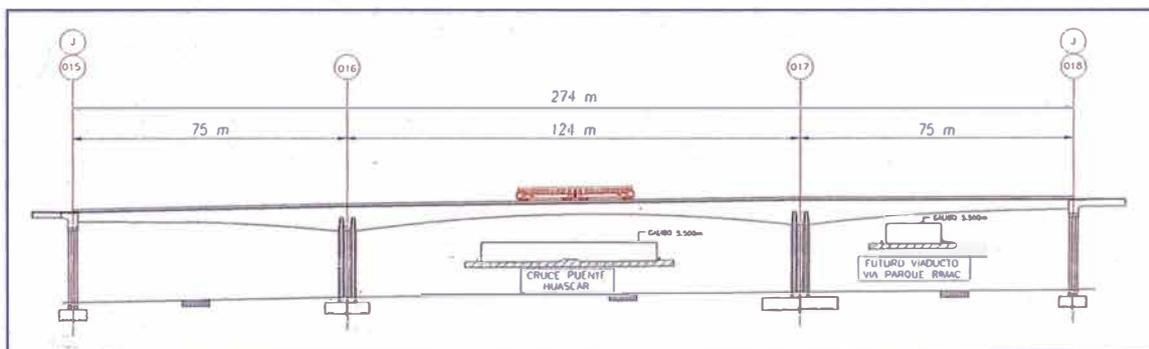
Alzado - Fuente: Consorcio Tren Eléctrico
